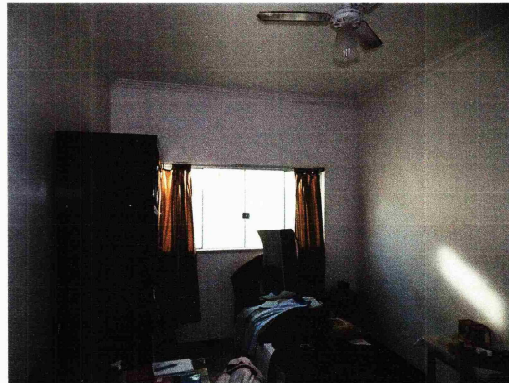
VISTA INTERNA QUARTO II – DETALHE PORTA E JANELA
